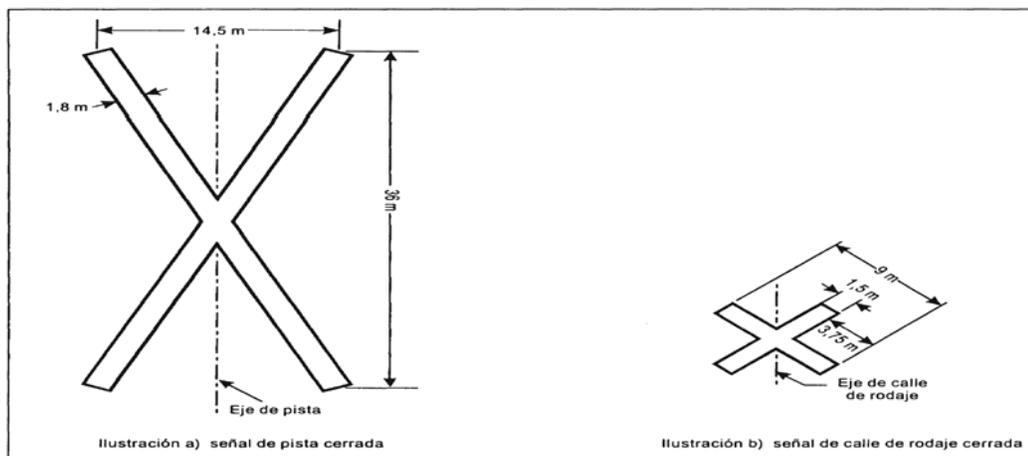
Señales de pista y de calle de rodaje cerradas
